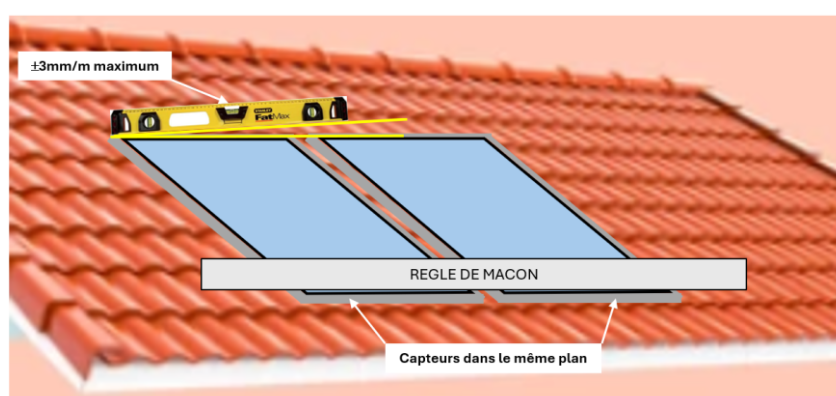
Installations auto-vidangeables – inclinaison nécessaire – Capteurs CMV - CSH
